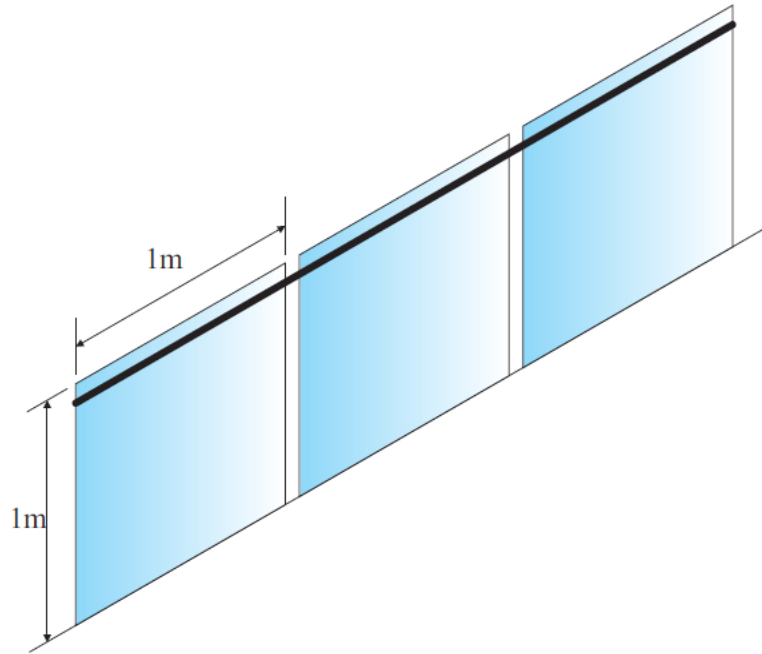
Rappresentazione schematica del parapetto oggetto di analisi.
